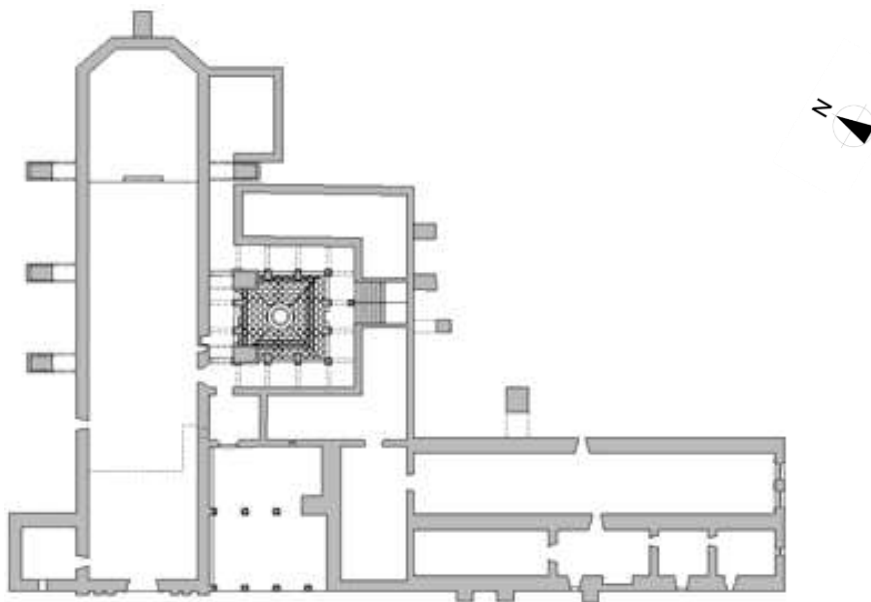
Modificación de la planta arquitectónica del monasterio de Tiripetío.1543-1550.³⁷
